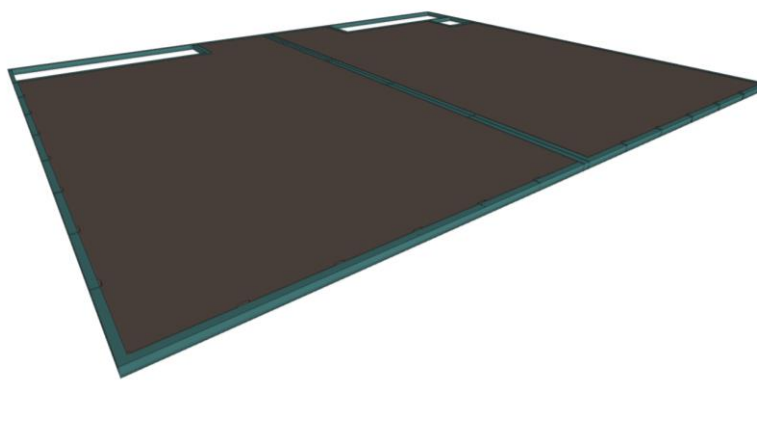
Planta de cimiento a -2.8 m de excavación.
